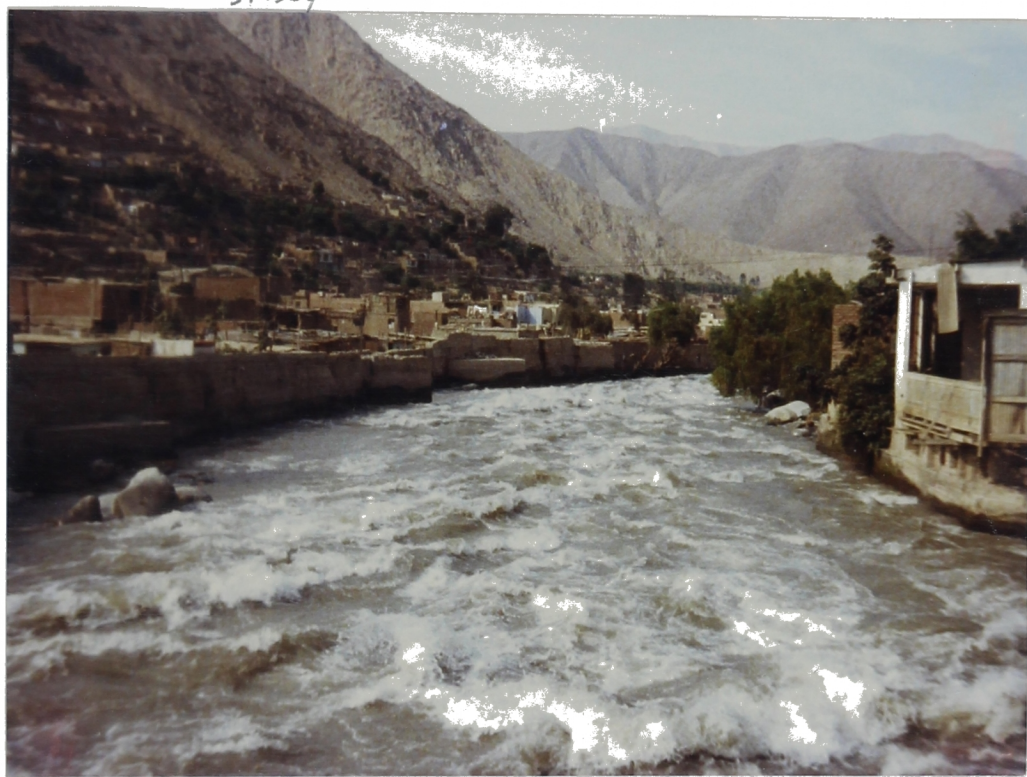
Km. 34+000 . Zona baja de Chosica protegida del Río Rímac mediante muros de concreto subdimensionados que ahora se hallan muy erosionadas.
